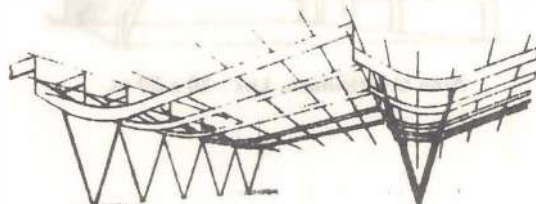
Distintos tipos de elementos estructurales en madera laminada.
